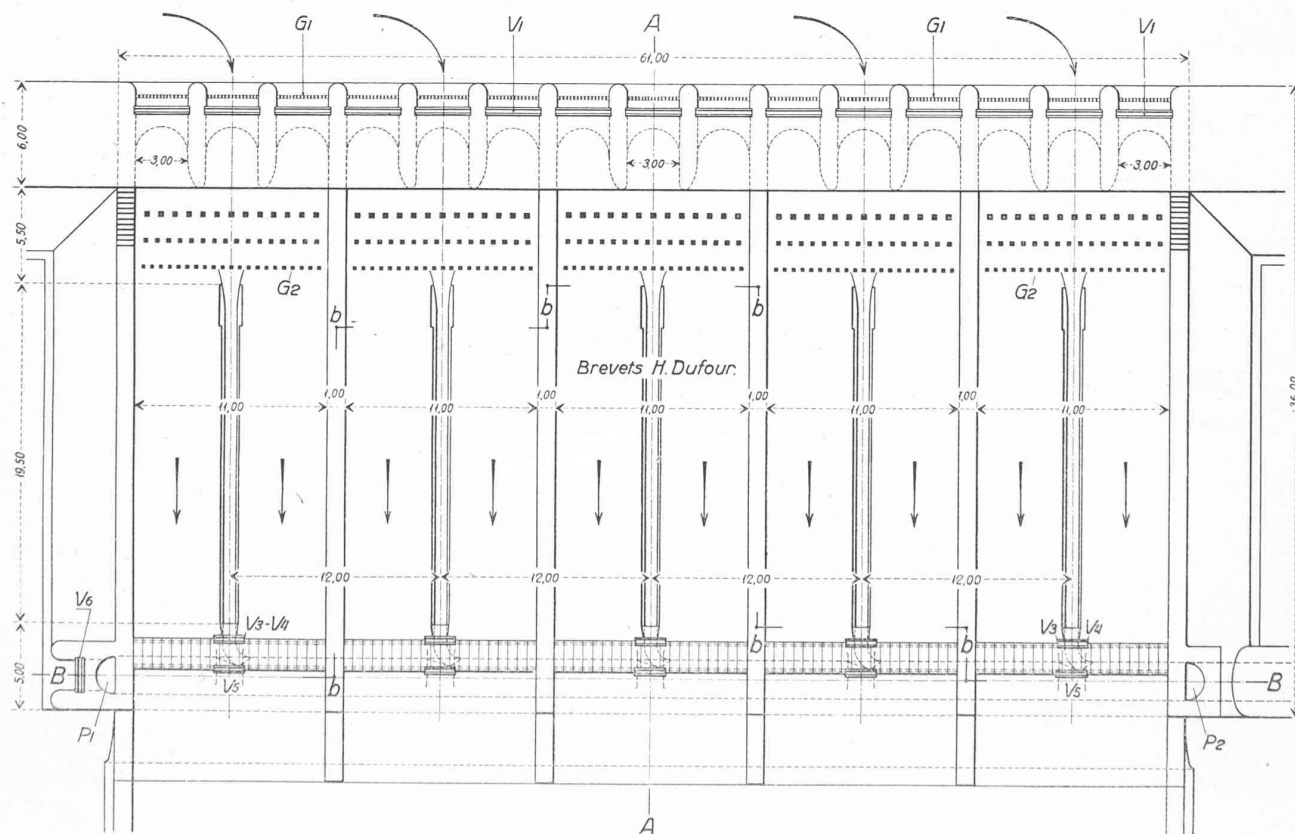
Vue en plan du dessableur de Ponte all' Isarco. Echelle 1 : 400.
